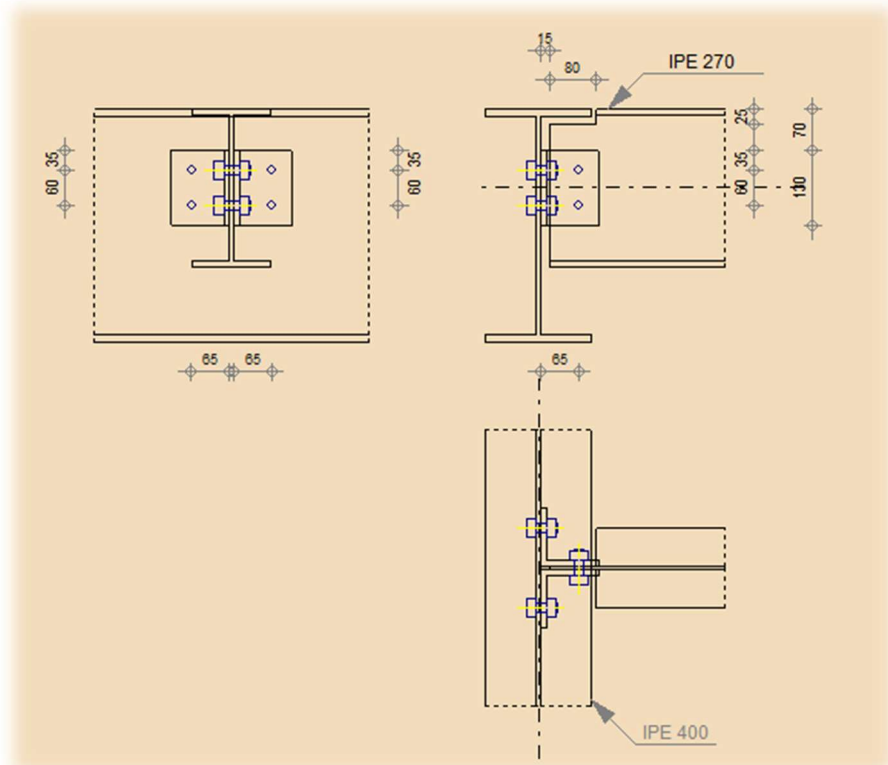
Détail d'assemblage poutre-solive (IPE400-IPE270)
